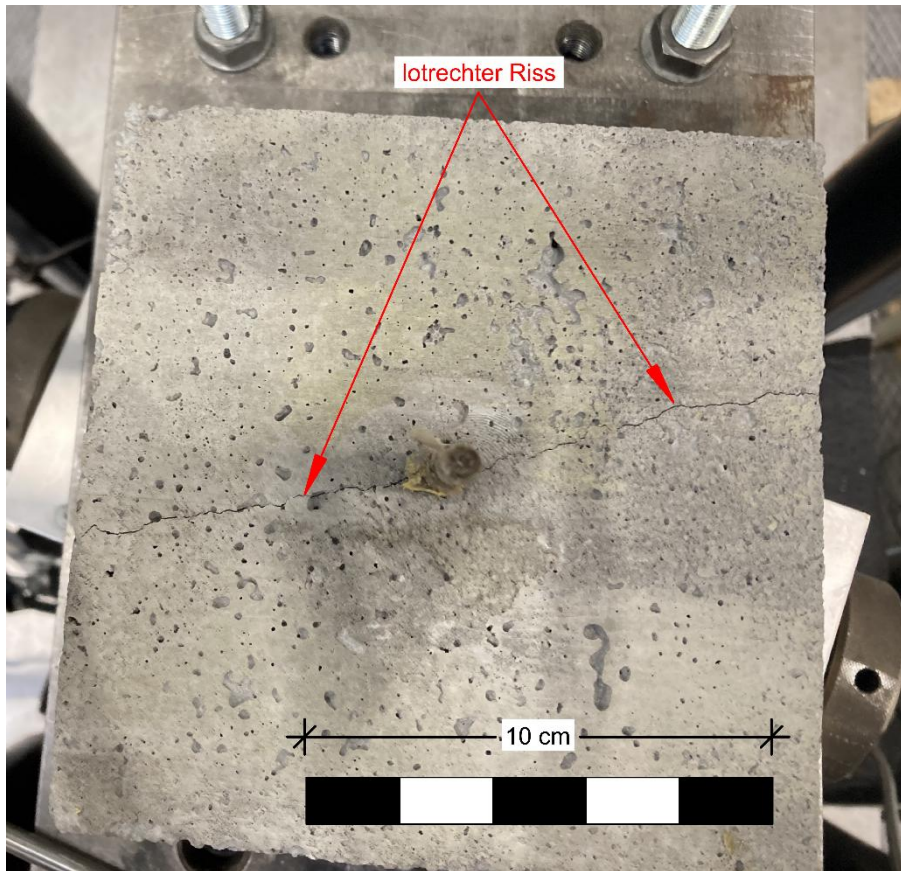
Lotrecht zur Bewehrung verlaufender Riss in Probekörper P8 mit „grob besandetem“ Hanfbastbewehrungsstab
